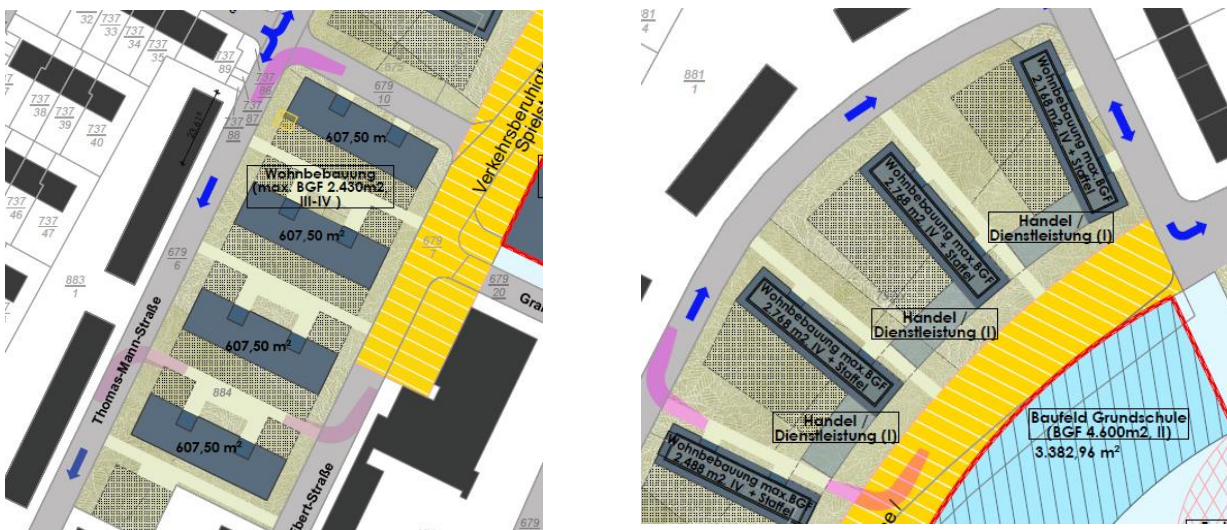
Städtebauliches Konzept mit Schlepplagen im Bereich der Wohnbebauung
